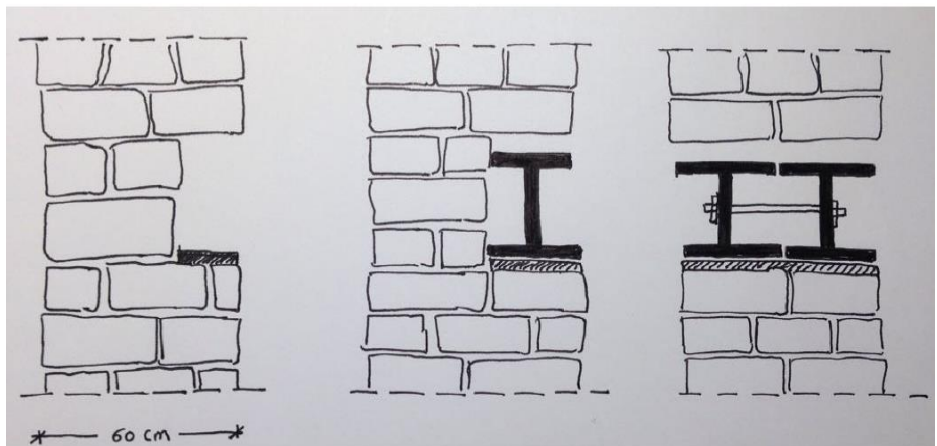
Detalles de colocación de perfiles. Fuente: Autor.
